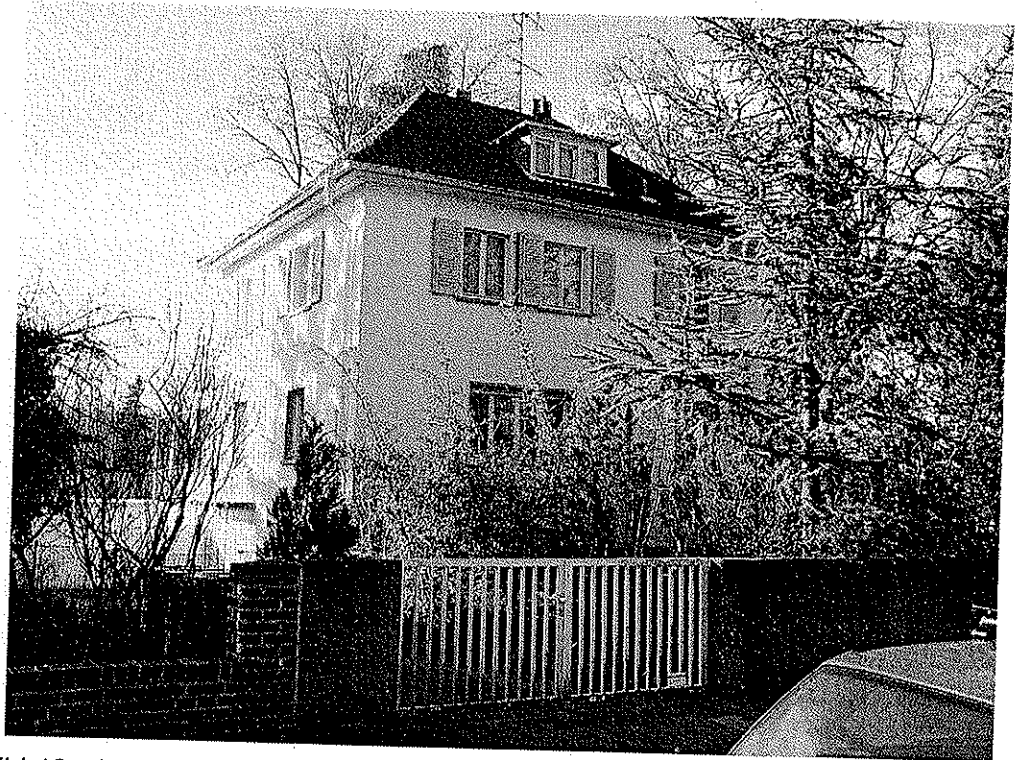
Walmdach mit sehr zurückhaltender Gaube (ca. 1/10 der Trauflänge).
